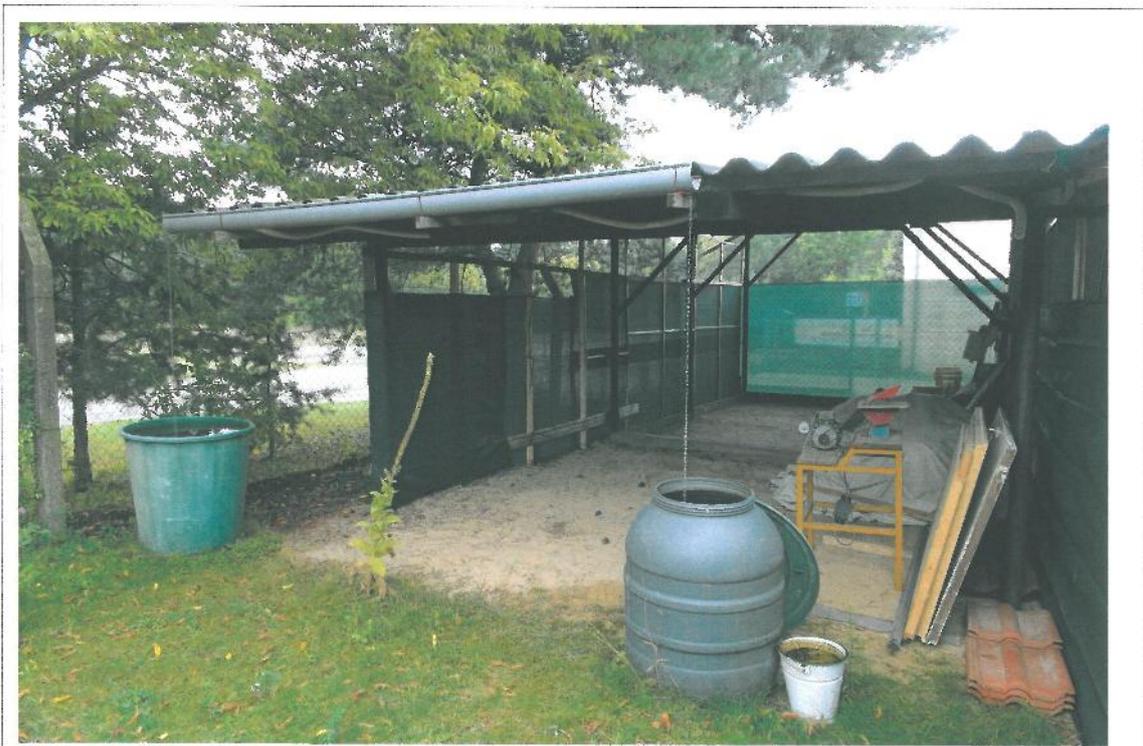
Fläche 1, Wilhelmstraße 102 / Schuppen
